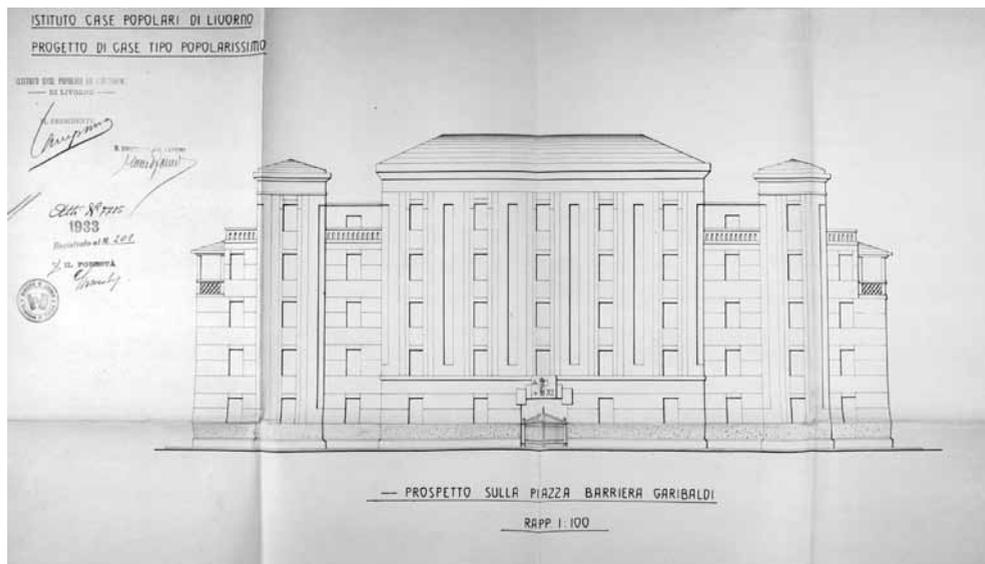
TULLIO FARNETI, Progetto di fabbricati di tipo popolarissimo Piazza Barriera Garibaldi, prospetto sulla piazza, 1933, Archivio Storico Comune di Livorno, Ufficio tecnico, *Concessioni edilizie approvate*, n. 7736-1933
